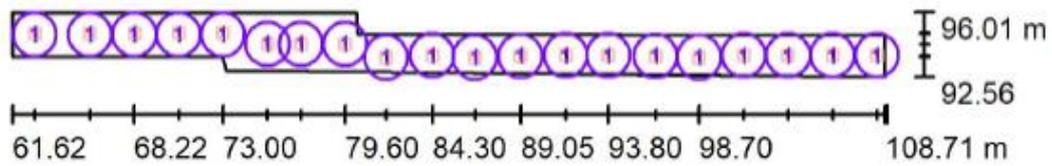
Disposizione in pianta degli apparecchi di illuminazione.
